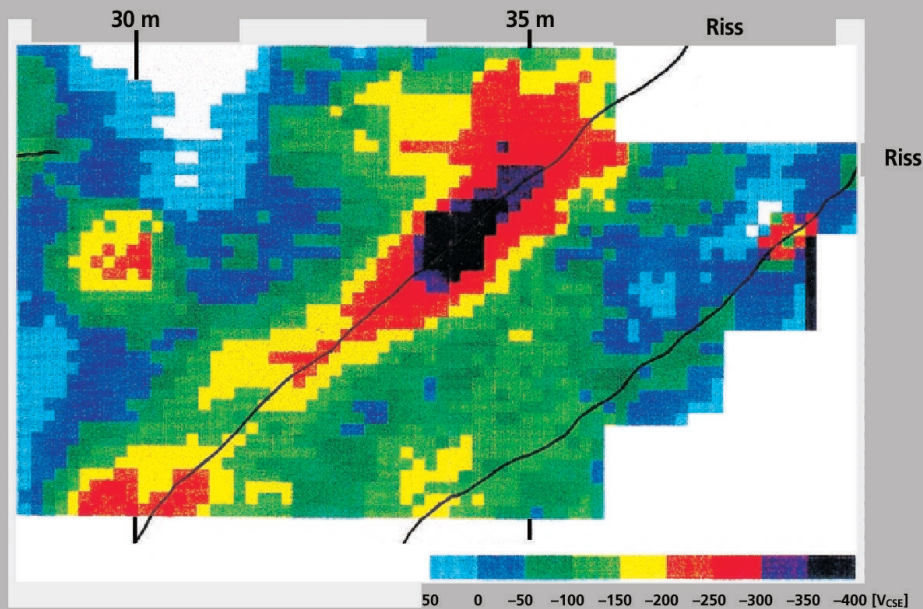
Potentialfeld der gerissenen Decke eines Parkhauses mit verstärkter Korrosion in Rissbereichen.
